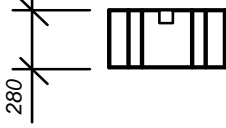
Фрагмент опирания плиты перекрытия на стену с привязкой 50
